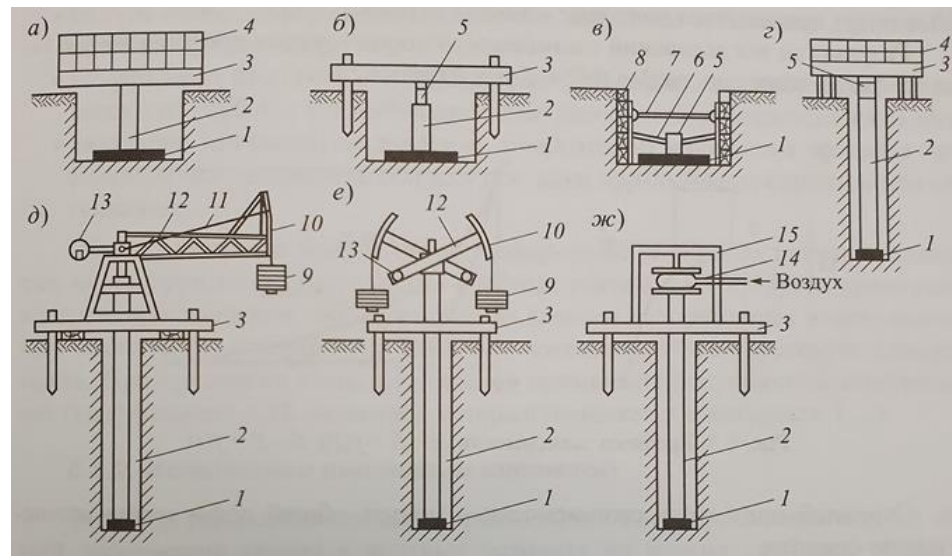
Схемы испытаний грунтов штампами:
